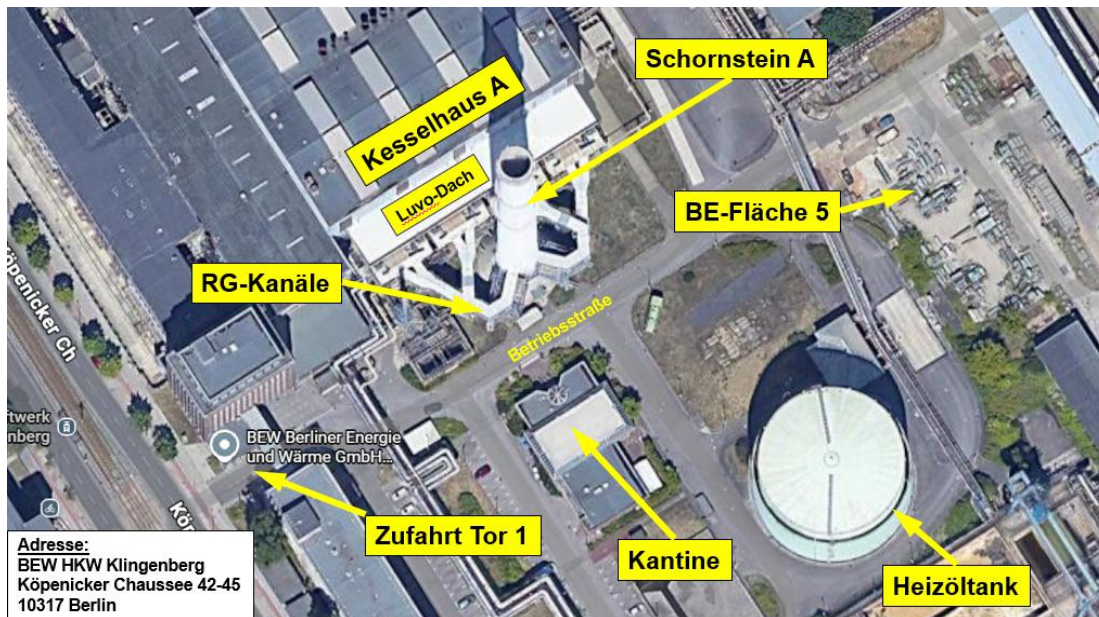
Lage der Baustelle mit umliegender Bebauung
